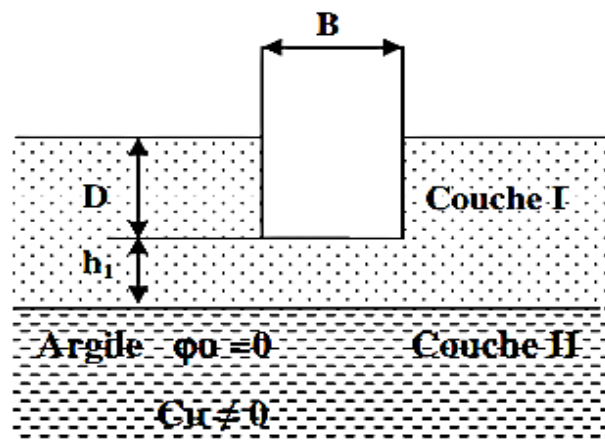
Semelle fondée sur un bicouche.<sup>29</sup>
